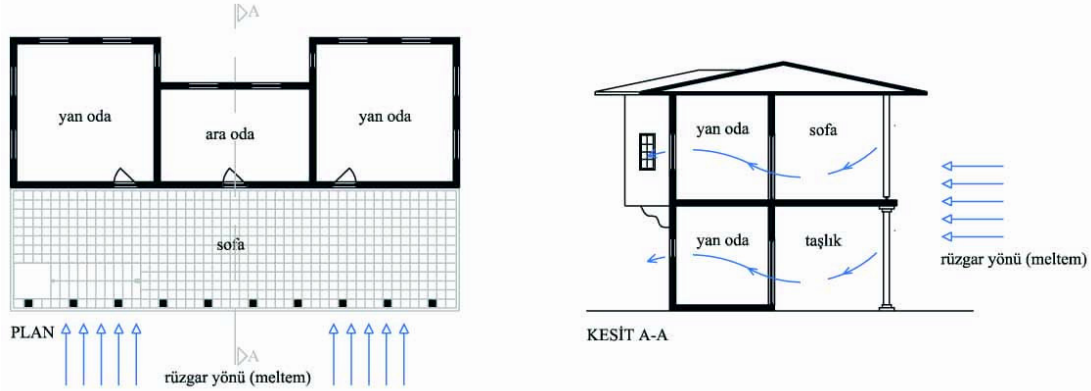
Yan (U) sofalı tip plan ve kesitleri
